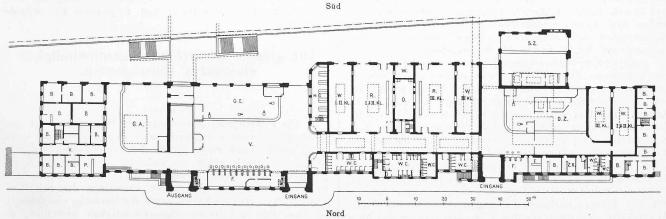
Grundriss vom Erdgeschoss. — Masstab I: 1200.
